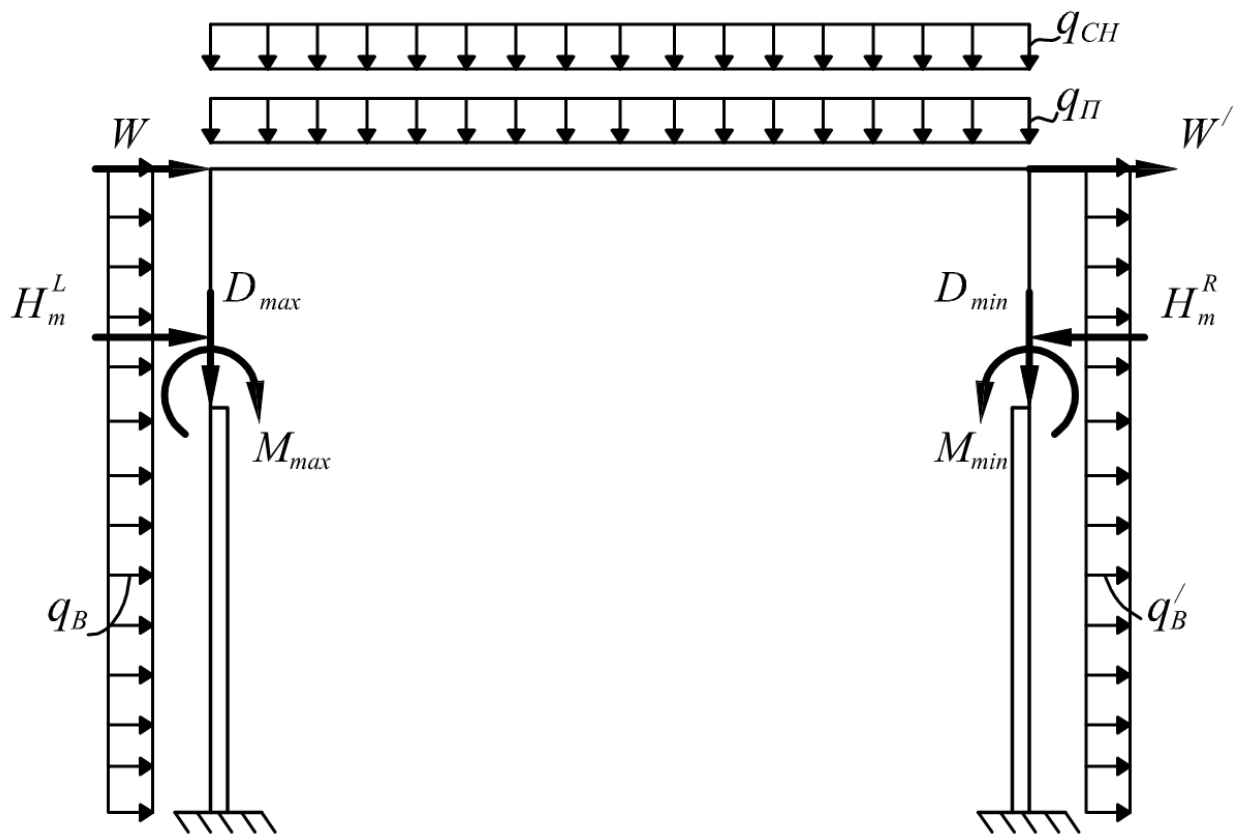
Схема прикладення навантажень на поперечну раму одноповерхової виробничої будівлі із мостовими кранами [2, 4]
